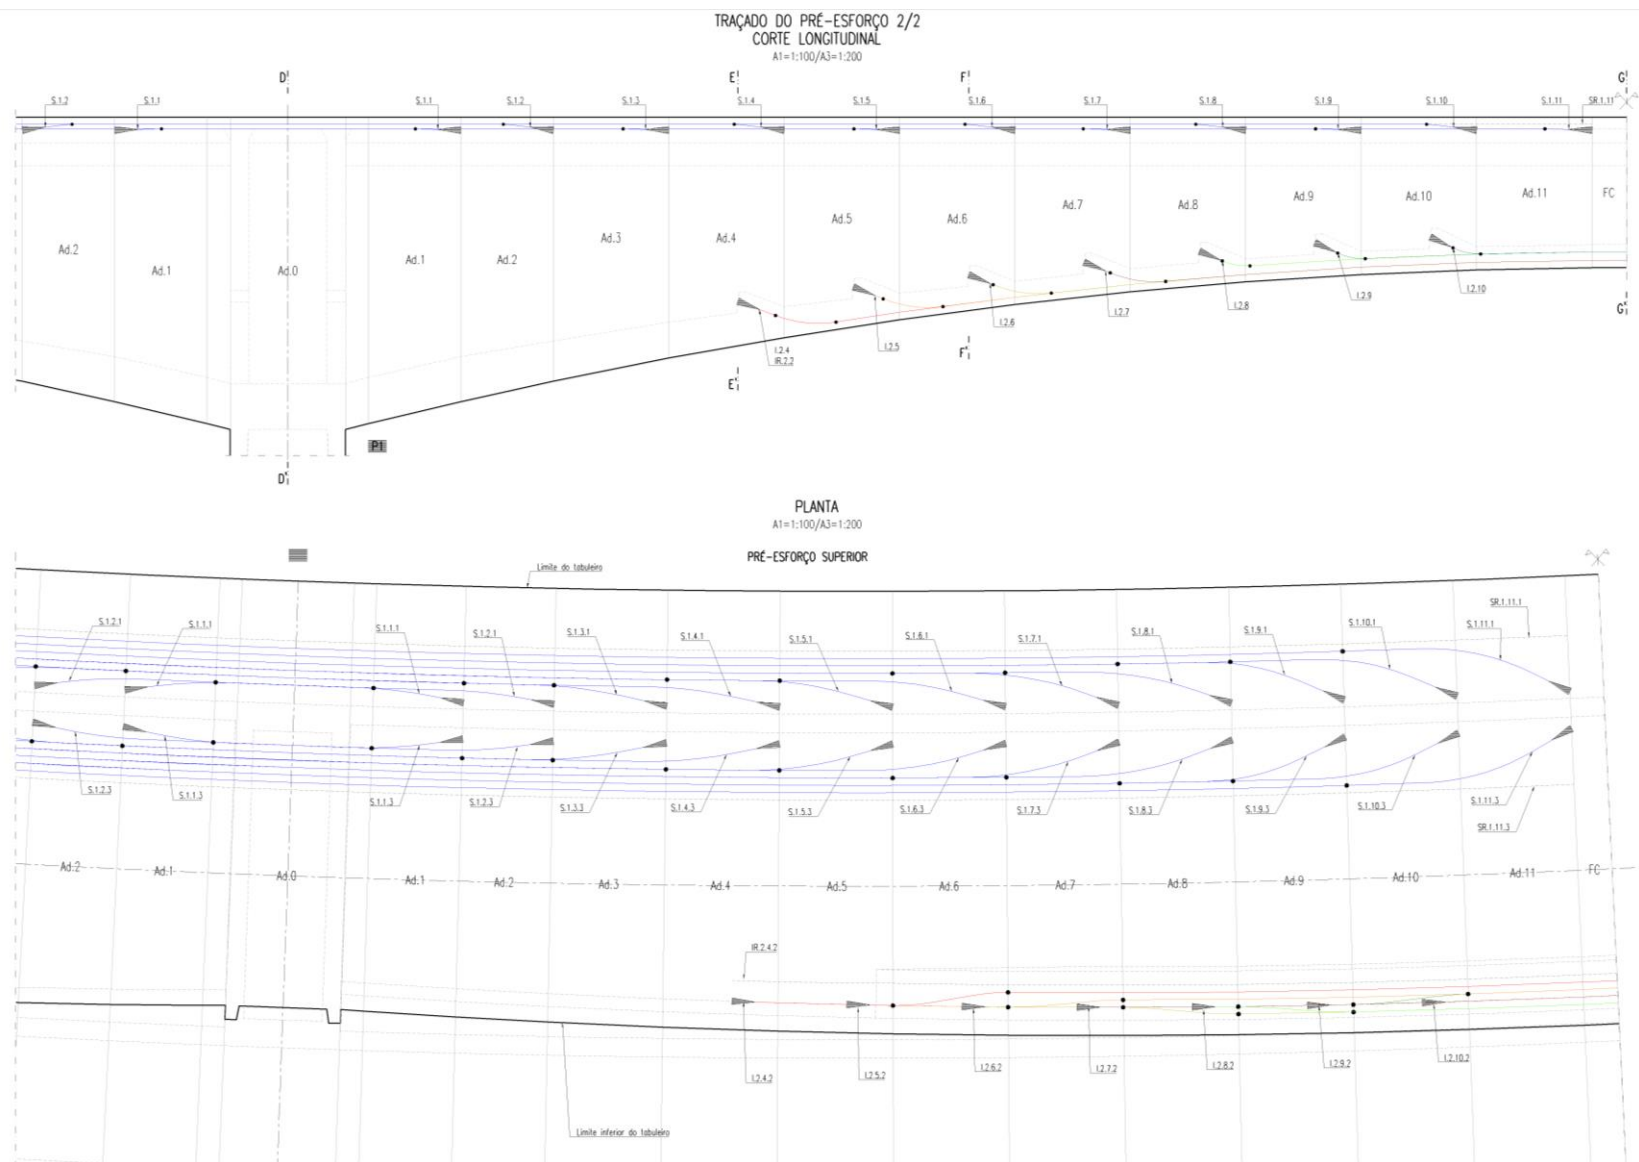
Traçado do Pré-Esforço. Peças Desenhadas do Projeto de Execução - 2/2
